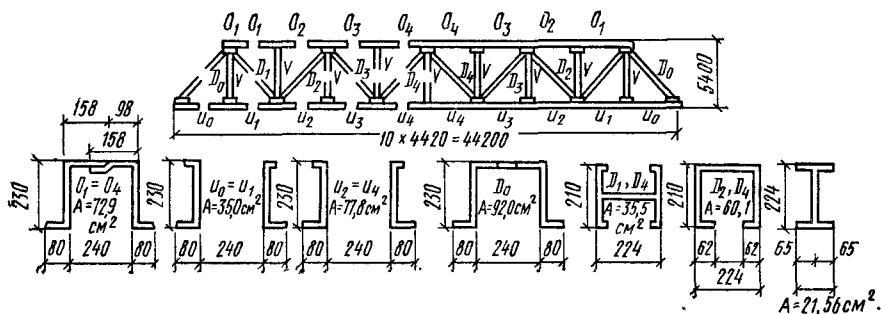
Профили стержней тяжелой фермы из алюминиевых сплавов
